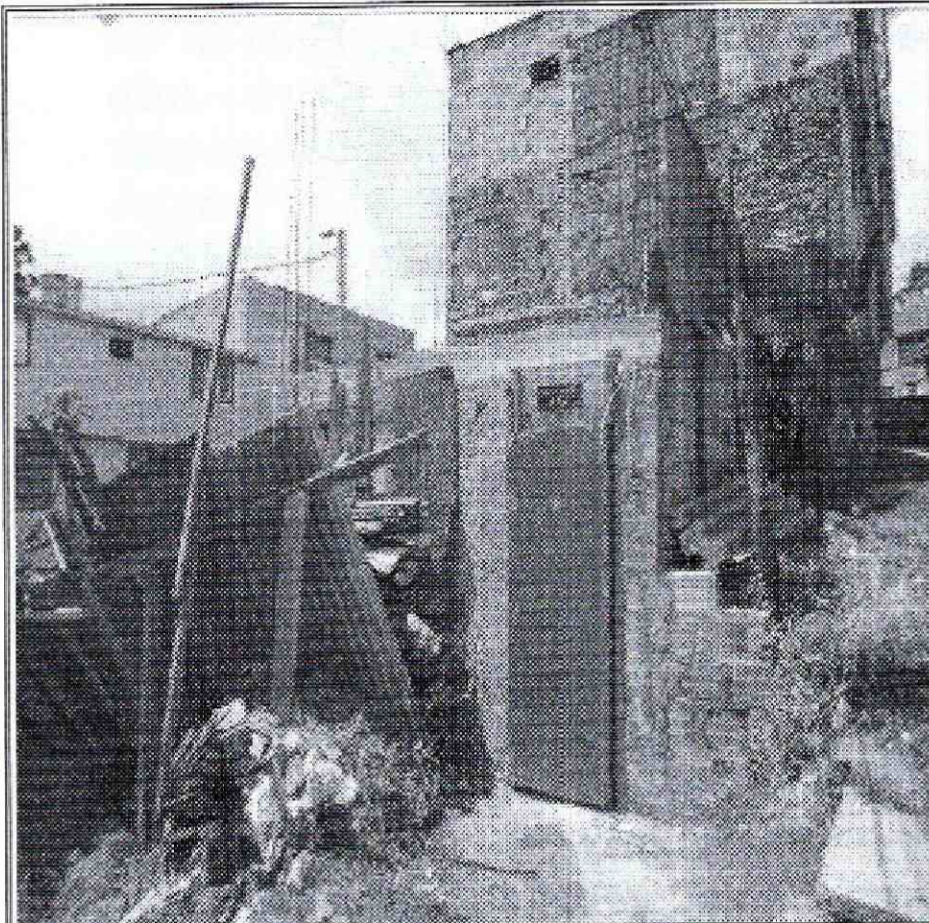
Vista del predio de la Diagonal 68 G Sur No. 1C – 16 Este
